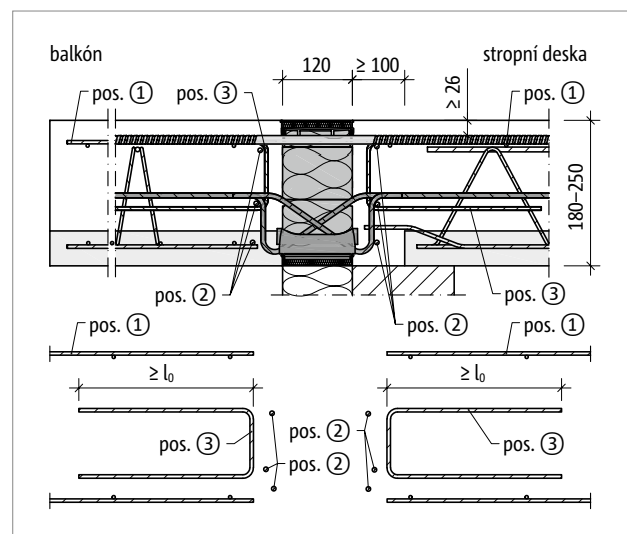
Schöck Isokorb® CXT typ KL-F: Napojovací stavební výztuž u balkónové desky tloušťky  $h = 180\text{--}250\text{ mm}$
